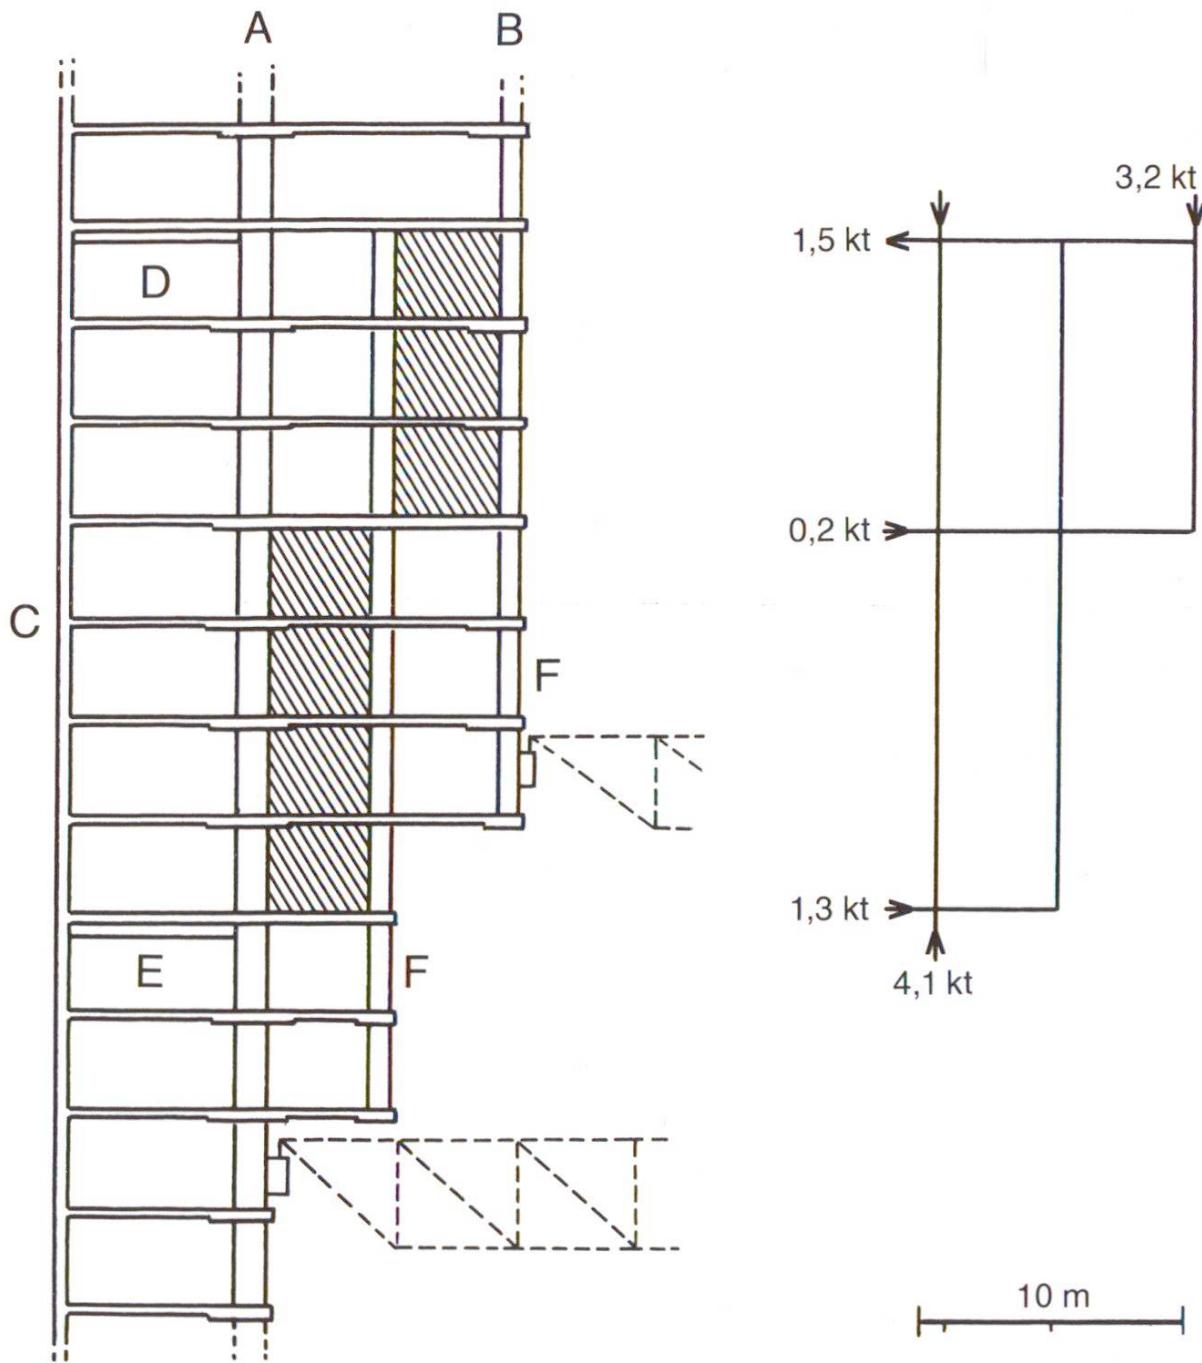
Disposition des parois raidissantes aux étages 9 à 15
